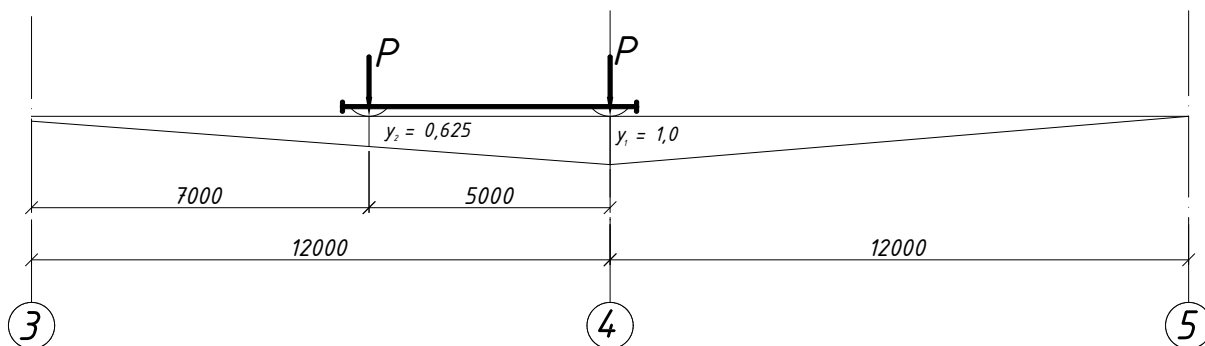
Загрузка колонны типовой (для расчетной рамы) оси одним краном
